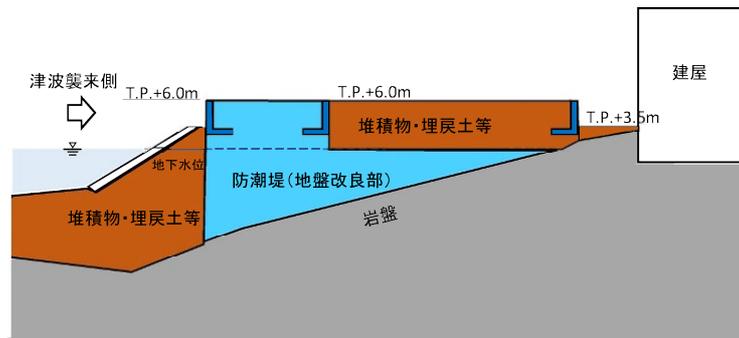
地盤改良部 断面図 (E-E 断面)
